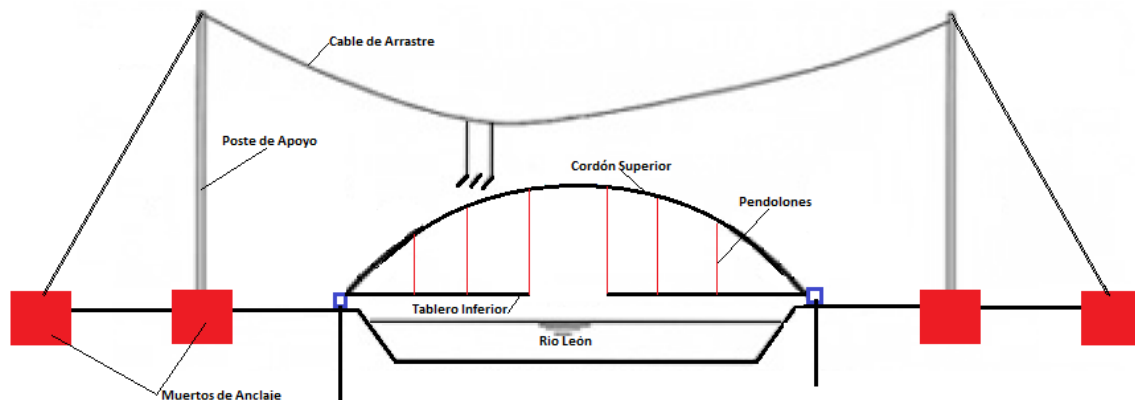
Alzado longitudinal montaje de pendolones y tablero inferior
